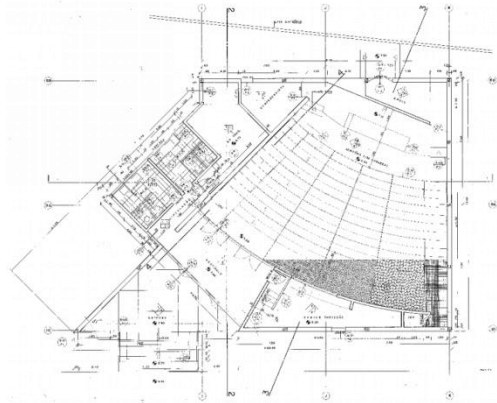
Planta baixa do auditório. Fonte: Acervo CBTU
